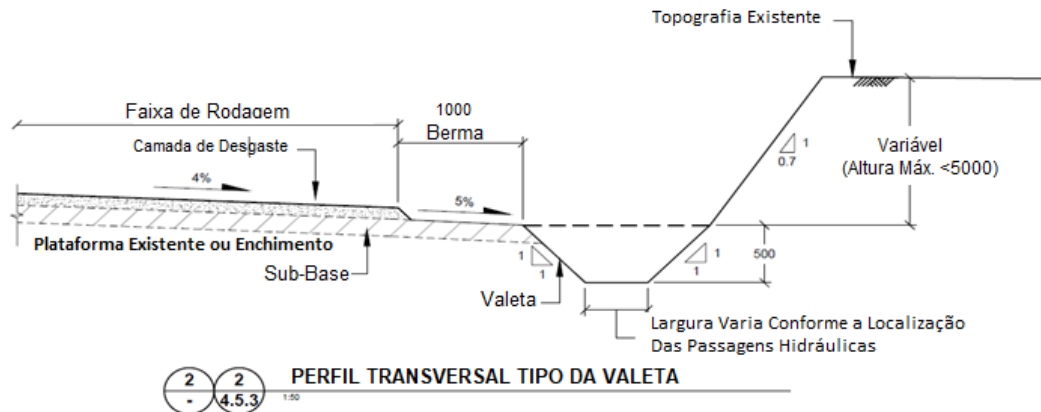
Secção transversal da estrada – escavação tipo 1.
